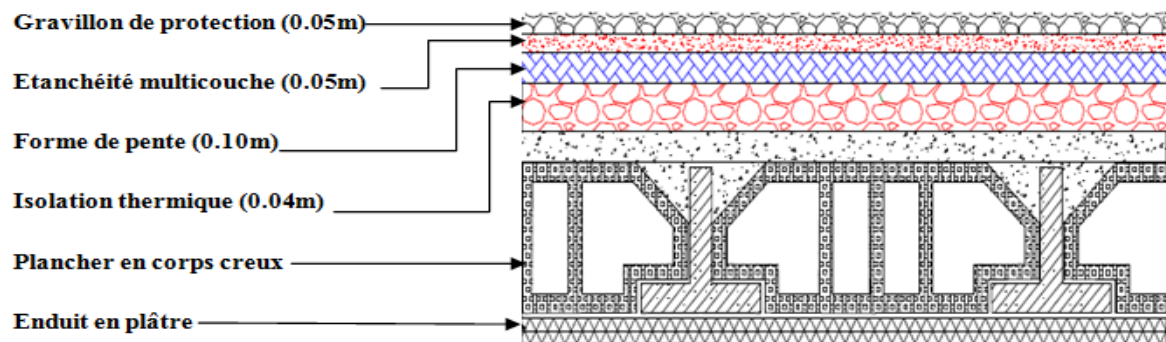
Schéma d'un plancher de terrasse inaccessible
